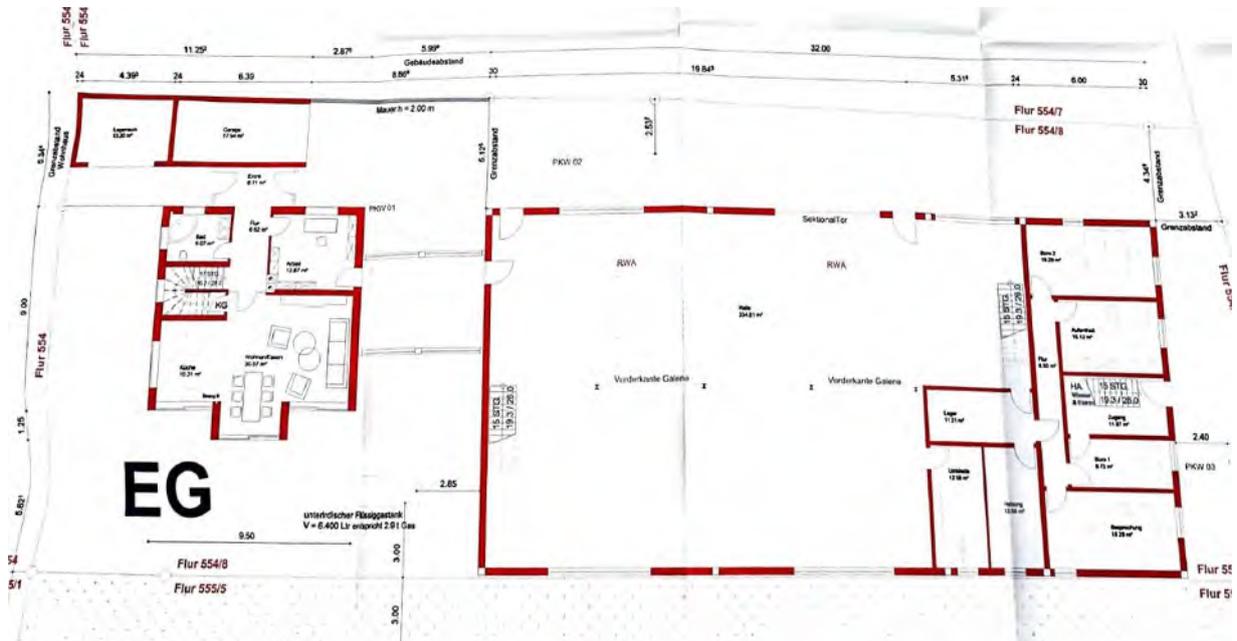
Grundriss Erdgeschoss - nicht zu Maßentnahme geeignet
